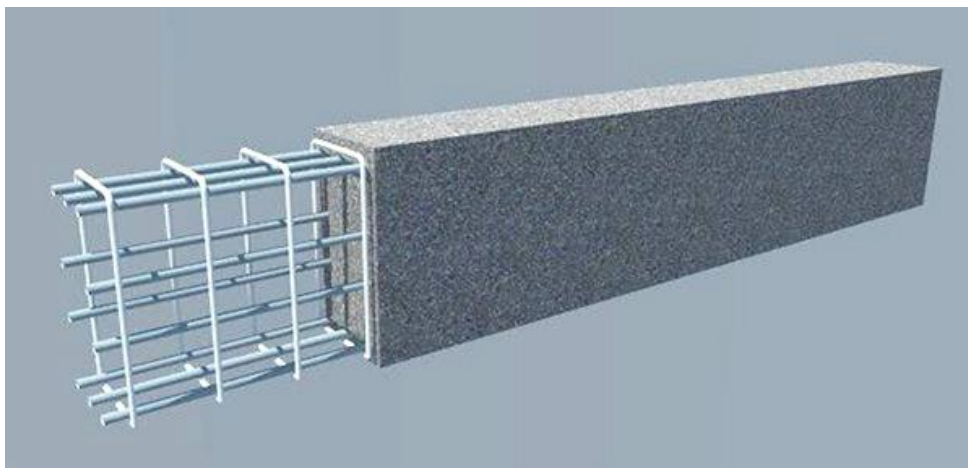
Exemplo de uma viga de betão armado [3].
